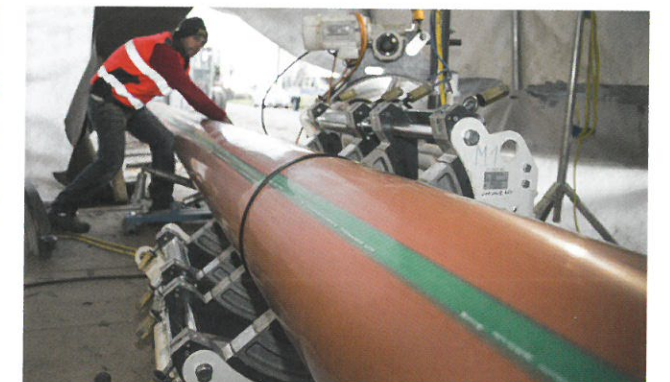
Auf perfekte Schweißwülste wurde bei diesem Projekt besonders geachtet. Die Schutzmantelrohre wurden millimetergenau in den Spannbacken der Schweißmaschine ausgerichtet und glatt gehobelt.
